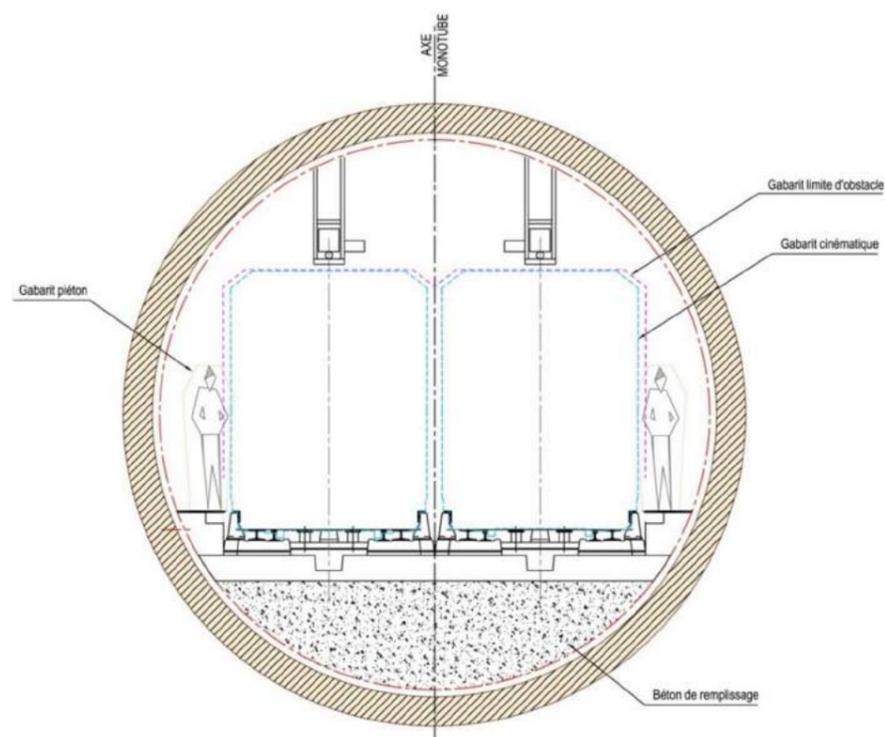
Coupe type du tunnel de la Ligne 14 Sud à deux voies en alignement droit
